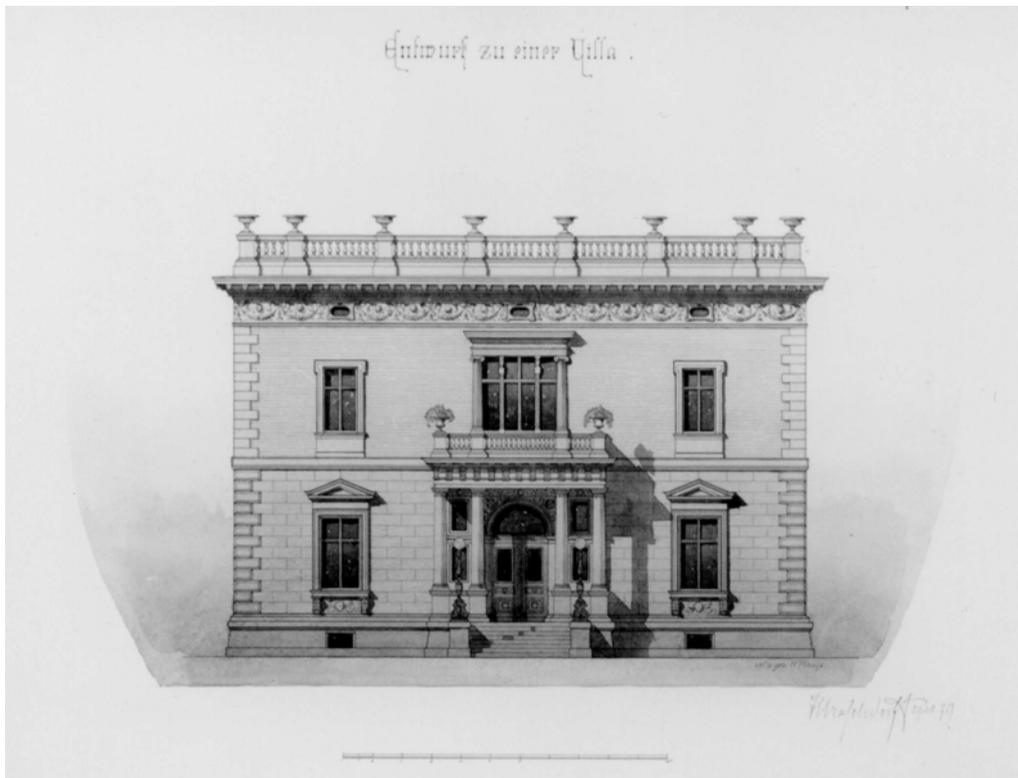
Heinrich Plange, Entwurf zu einer Villa, Eingangsfassade, 1879
